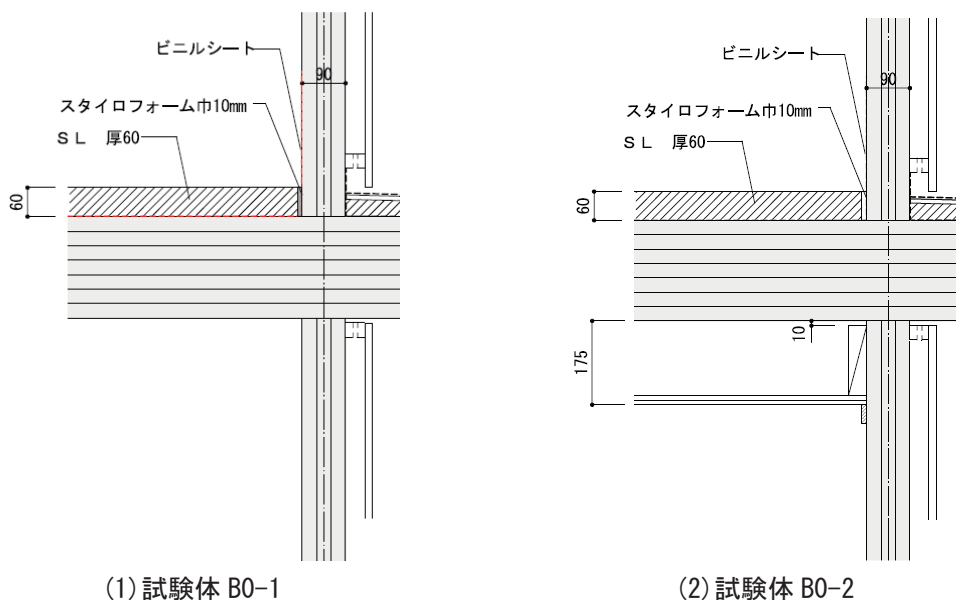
セルフレベリング材を施工した試験体の断面仕様
